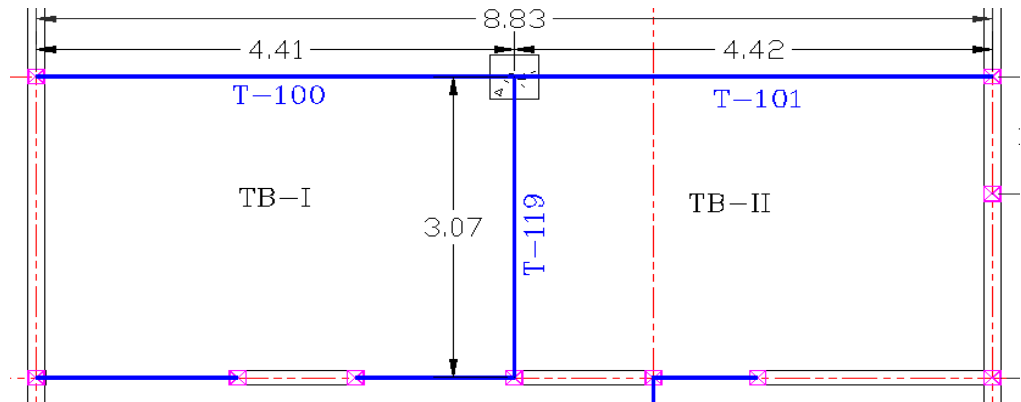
Fragmento del plano de estructuración donde se encuentra la columna 01.
